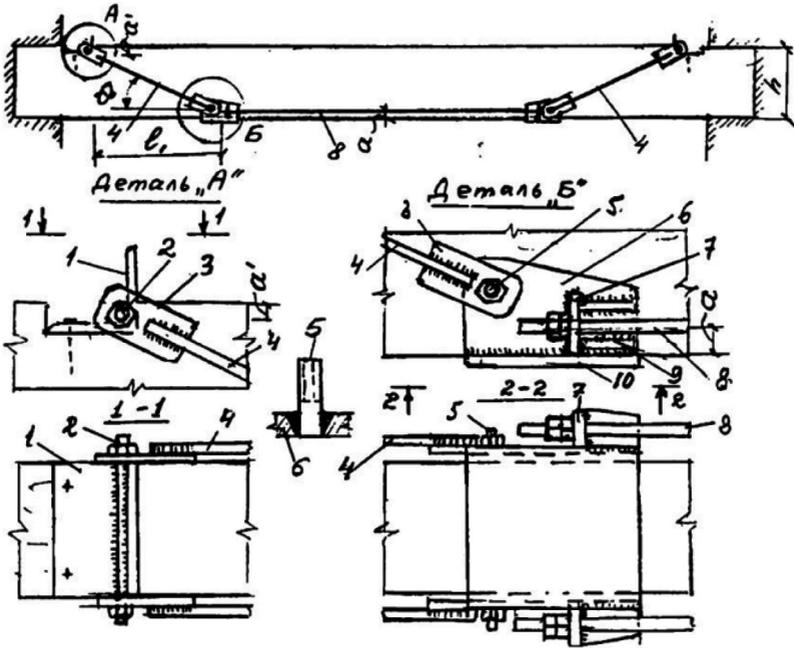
Схемы усиления деревянной балки разгружающей конструкцией:
